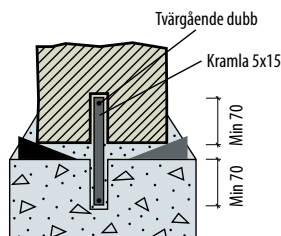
Detalj, förankring av blocksten med kramla i betongplatta
